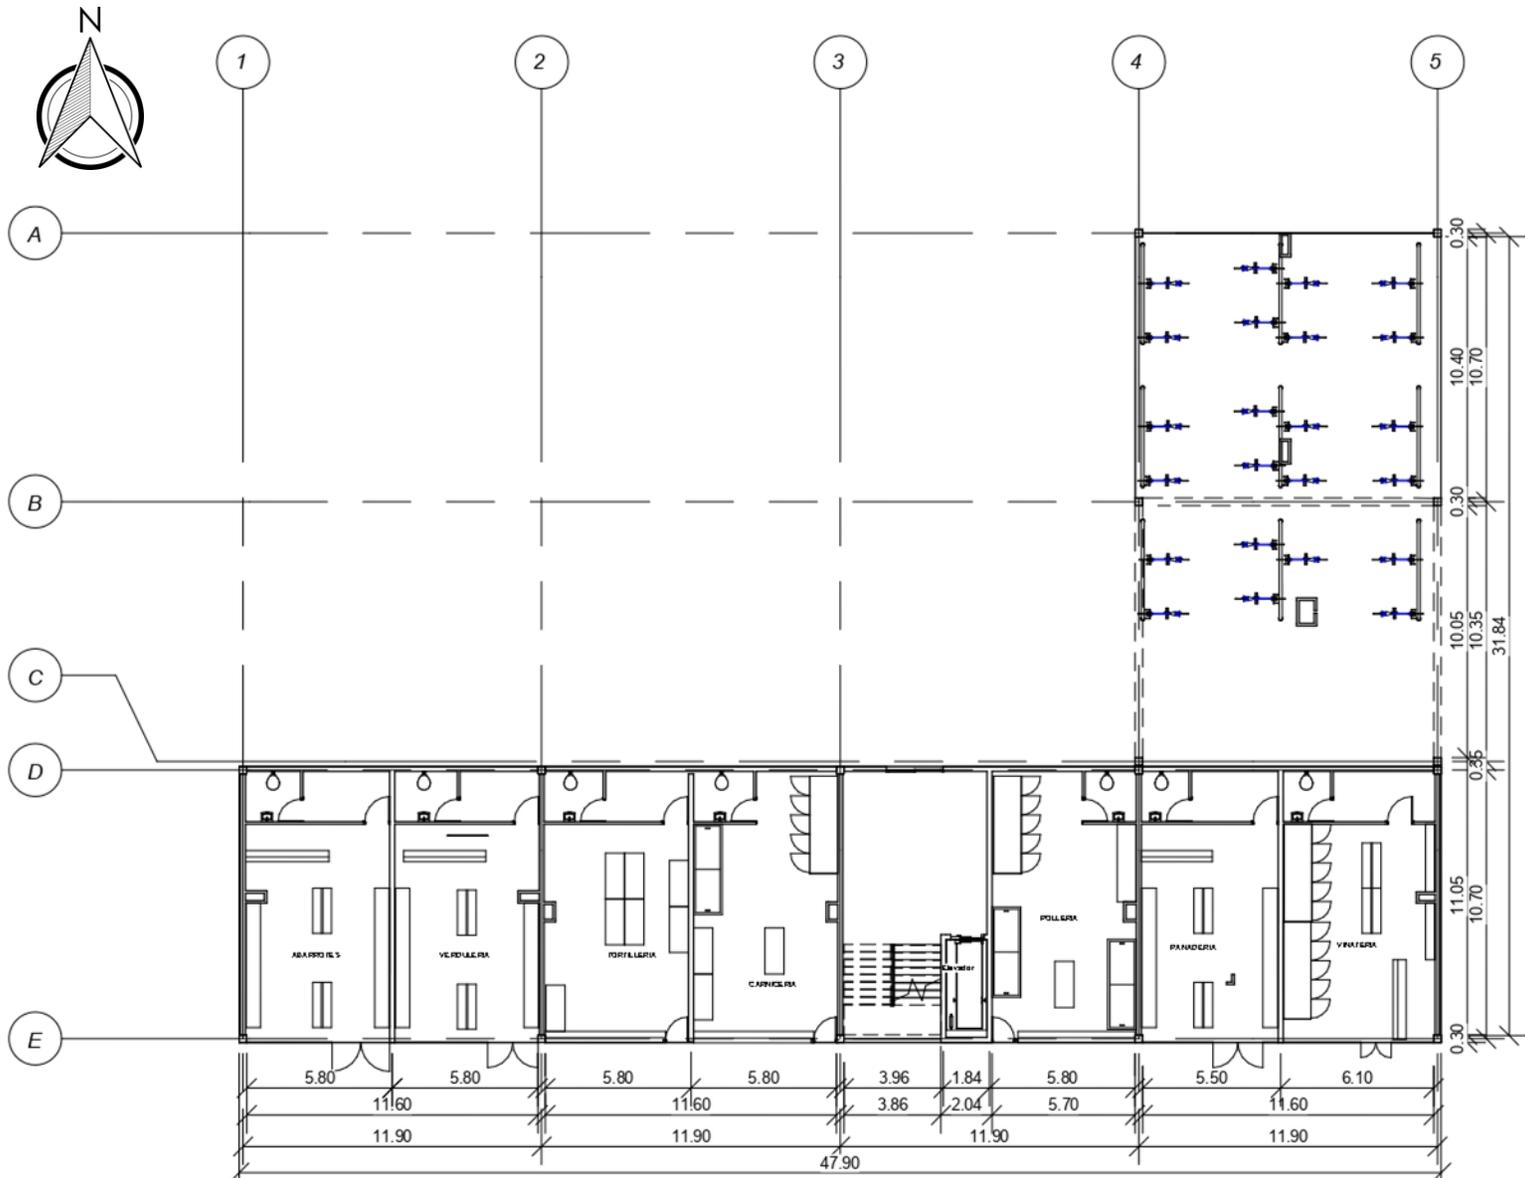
Propuesta final. Planta baja. Elaboración propia. 2022
